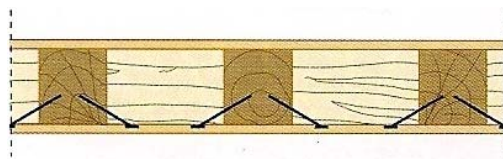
Tarugamento de pavimento de madeira [1].
